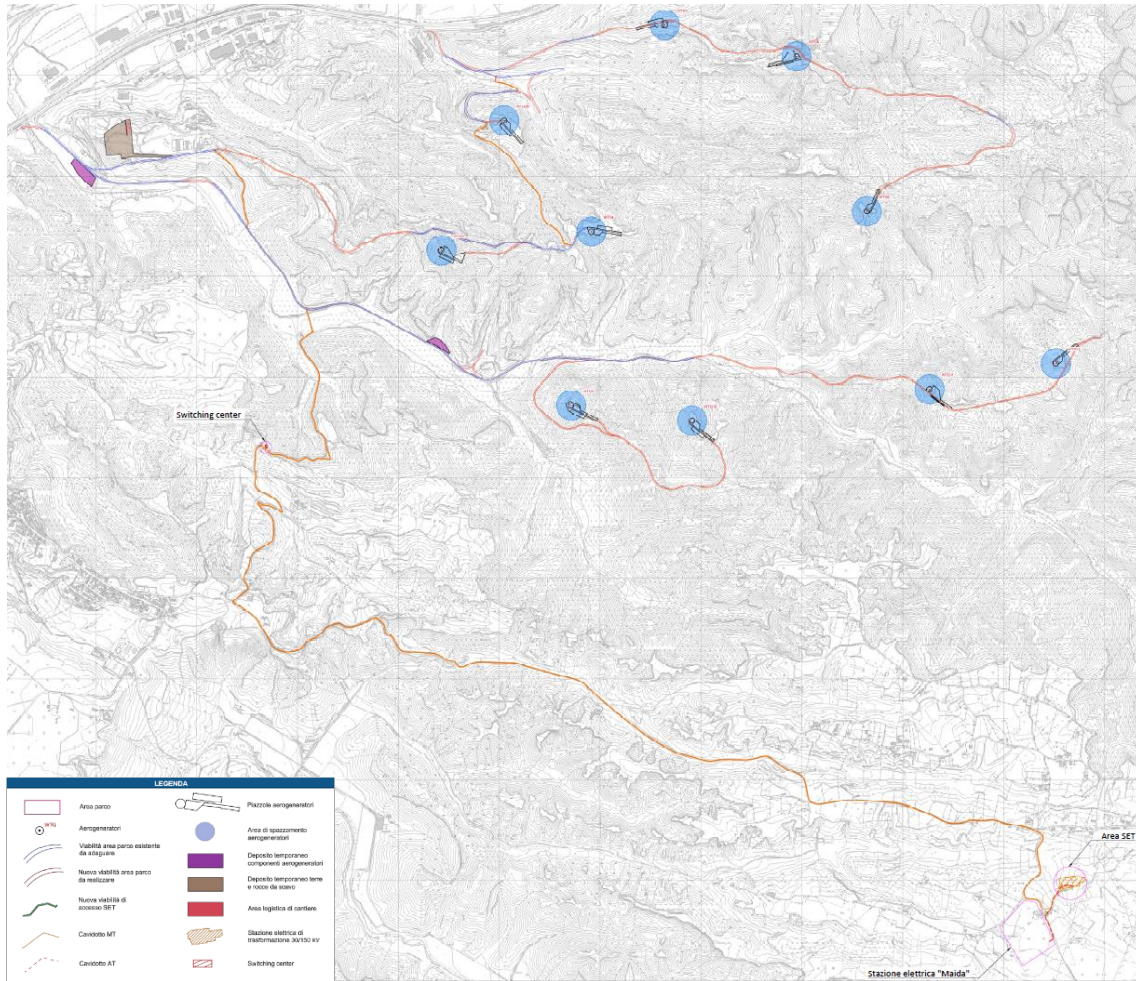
Planimetria di ubicazione dell'area parco su CTR
